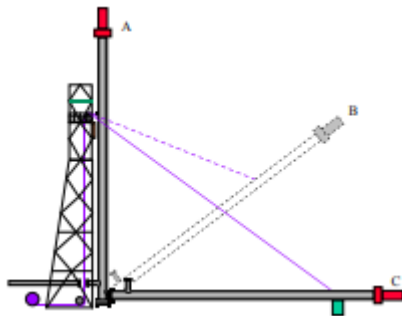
Flare Derrick desmontable de fusta integral
